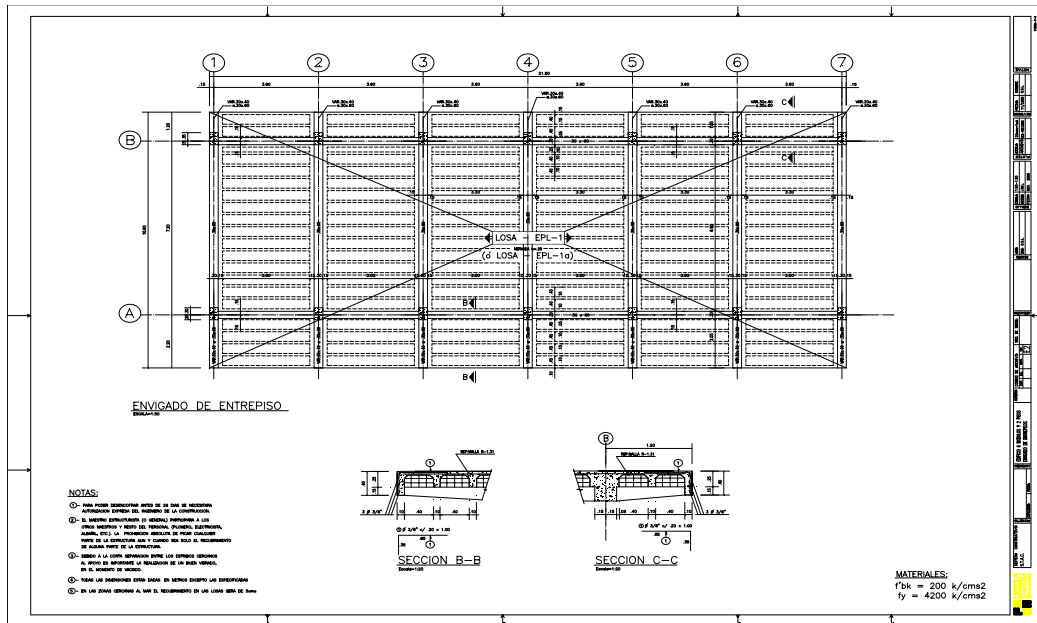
Envigado de entrepiso. Tipo STAC
